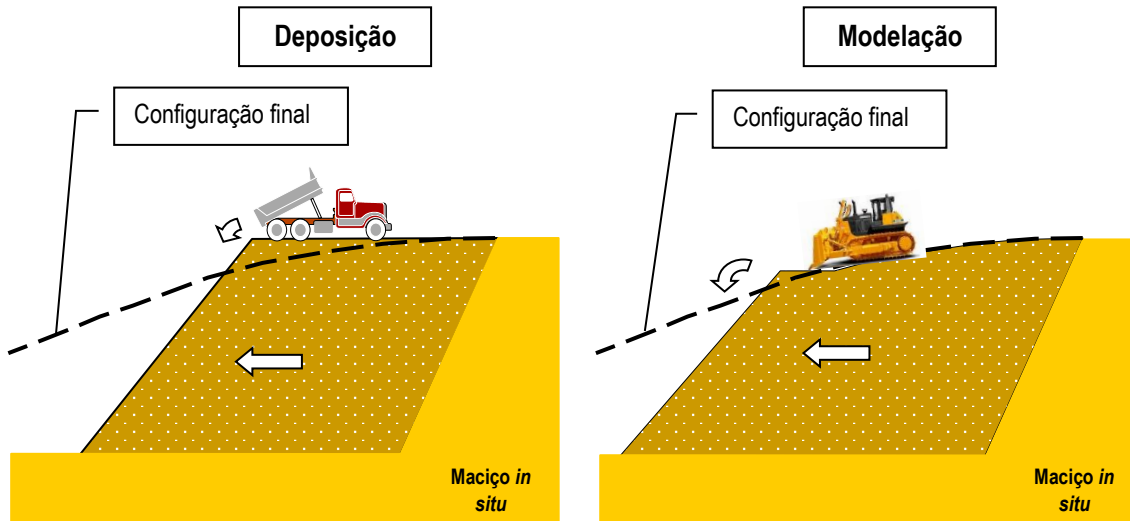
Perfil esquemático do método construtivo para o preenchimento dos vazios de escavação.
